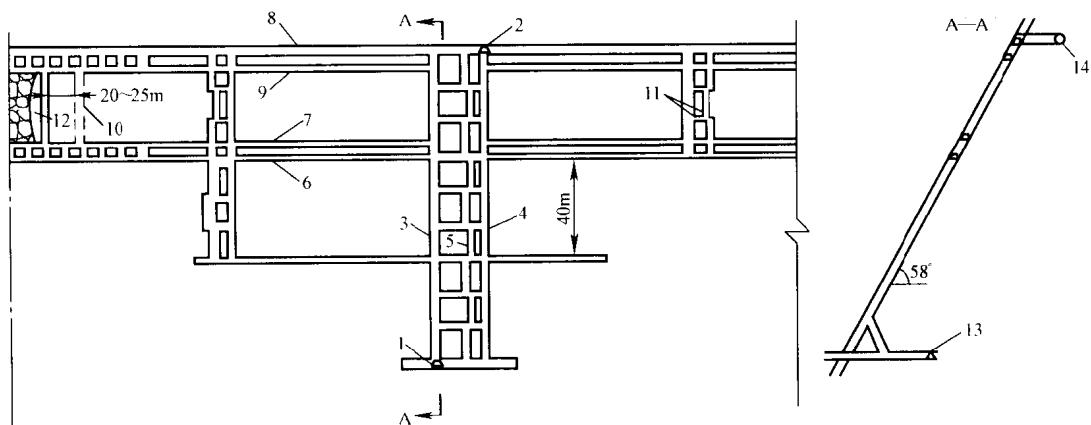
江西乐平矿务局涌山煤矿钢丝绳煤锯采煤采区巷道布置立面图及剖面图
